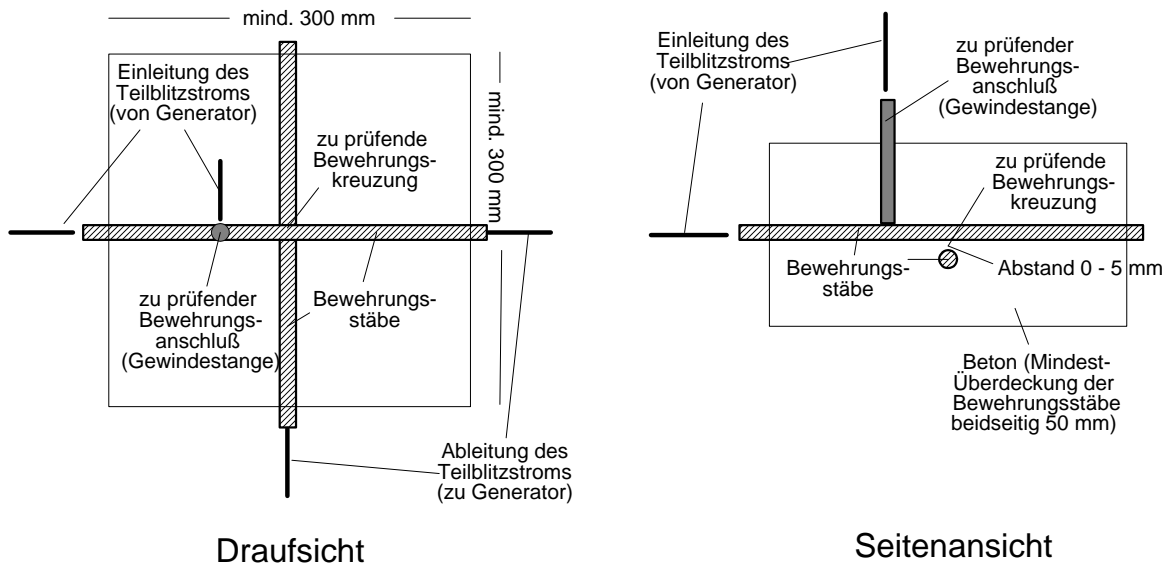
Prüfling A: Quadratischer Betonkörper mit einer Bewehrungsstab-Kreuzung.
